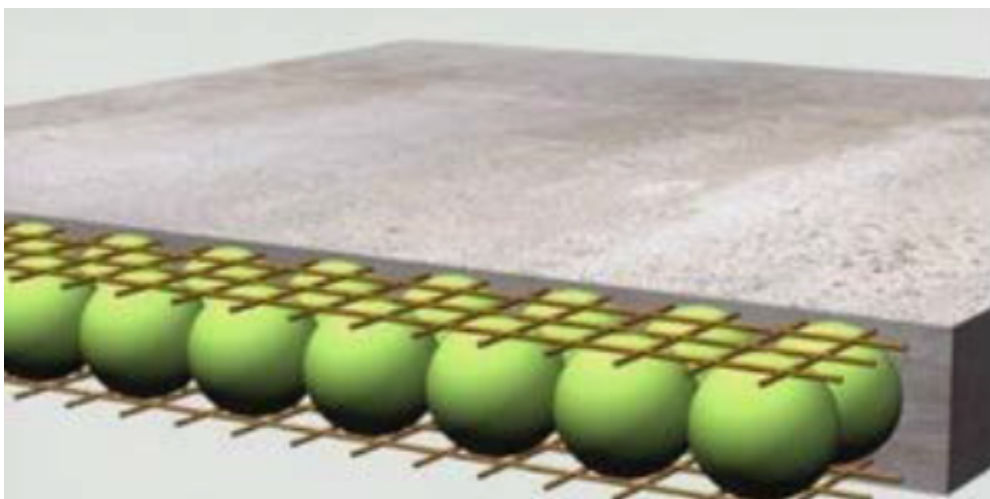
Laje *Bubbledeck* tipo painel acabado, *Bubbledeck Brasil* (2016)
